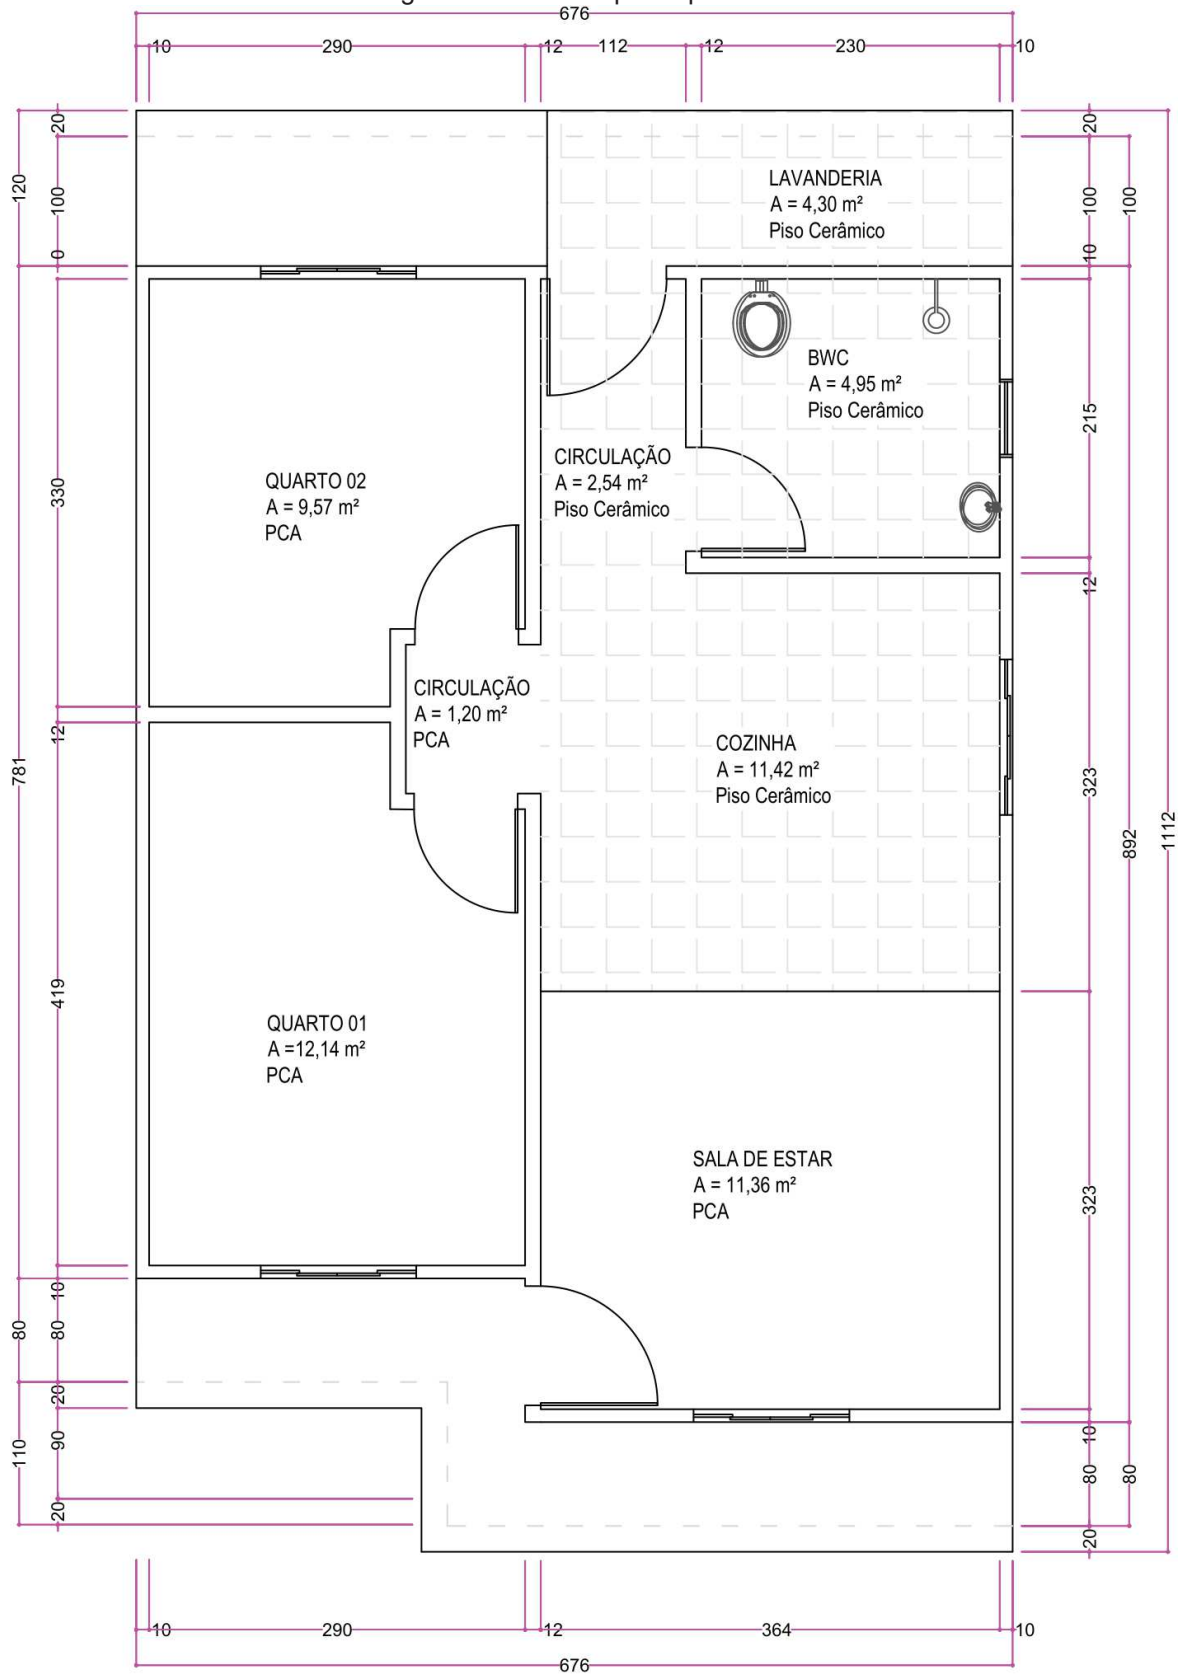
Planta baixa das casas geminadas do conjunto habitacional jardim das Orquídeas
